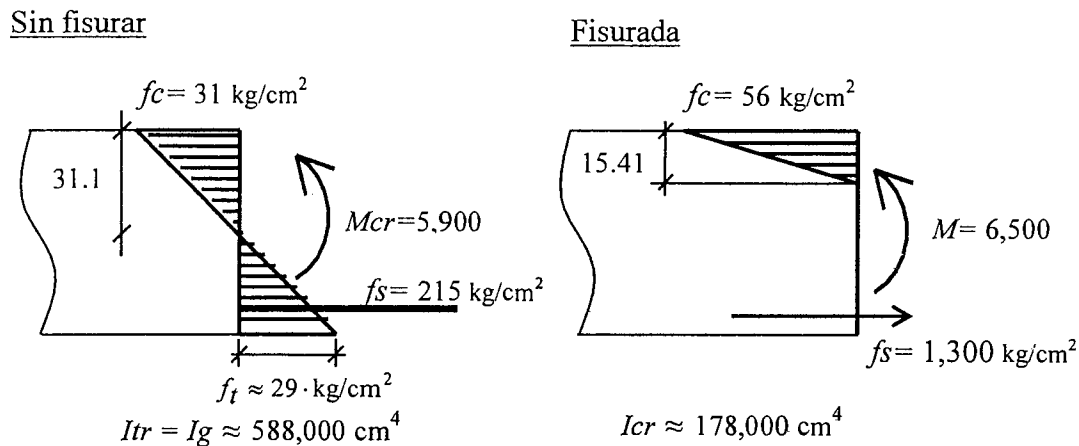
Esfuerzos en la sección no fisurada y fisurada.
